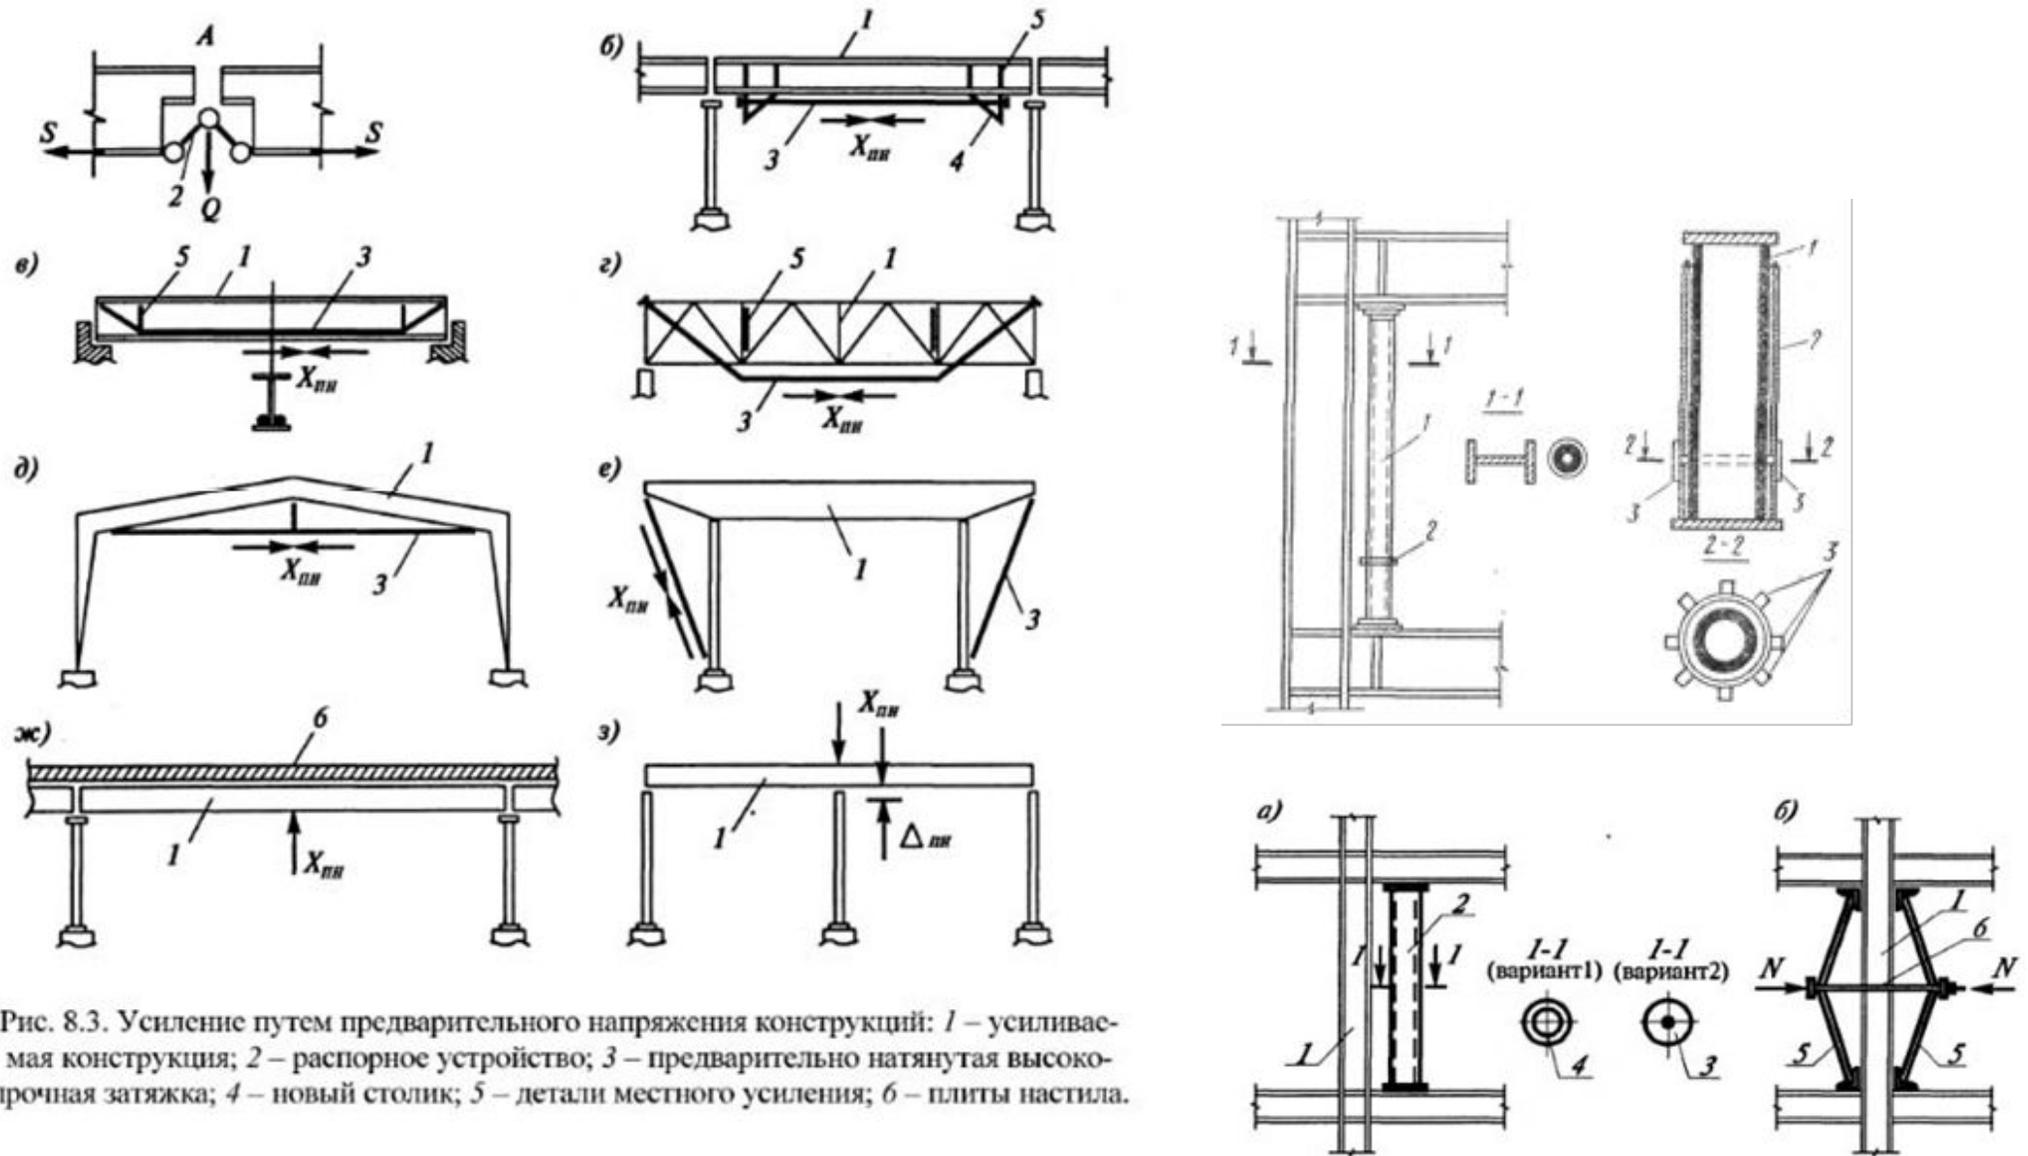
Усиление путем предварительного напряжения конструкций: 1 – усиливаемая конструкция; 2 – распорное устройство; 3 – предварительно натянутая высокопрочная затяжка; 4 – новый столик; 5 – детали местного усиления; 6 – плиты настила.
